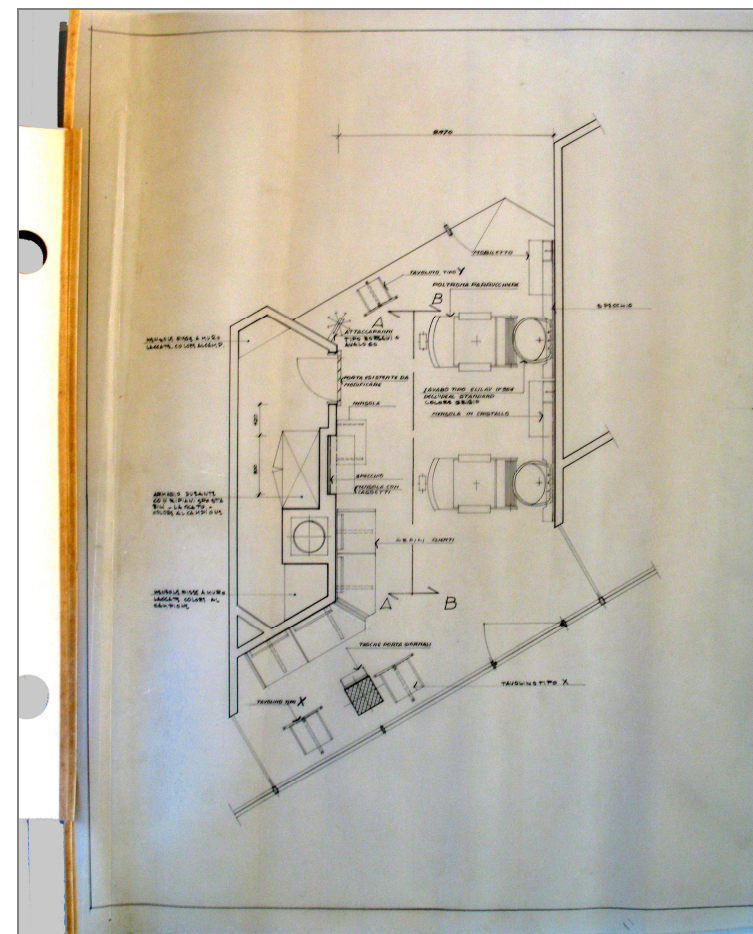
corpo ristorante – negozio parrucchiere (fonte CSAC – stralcio tav. 222, archivio n. 181-1)
